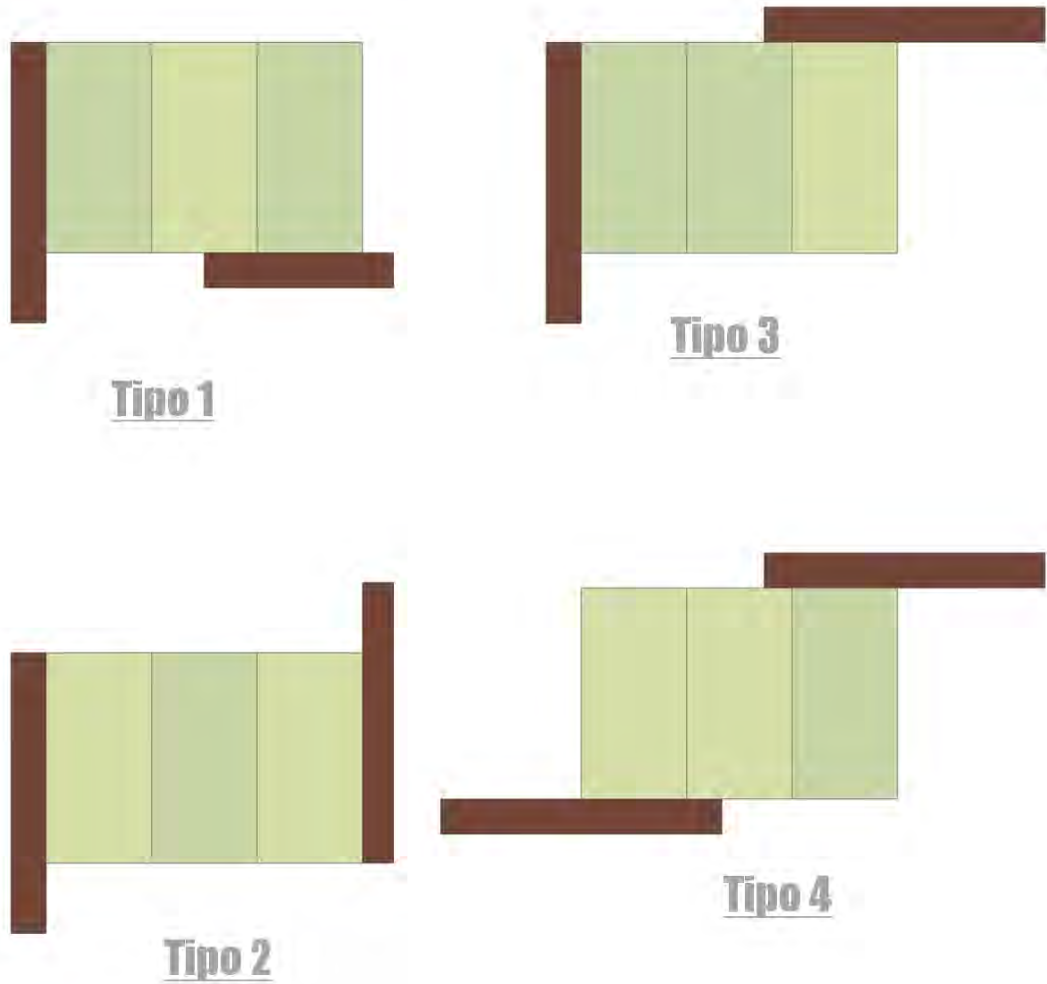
Planta Modulo mobiliario urbano en conjunto banca y piso.
